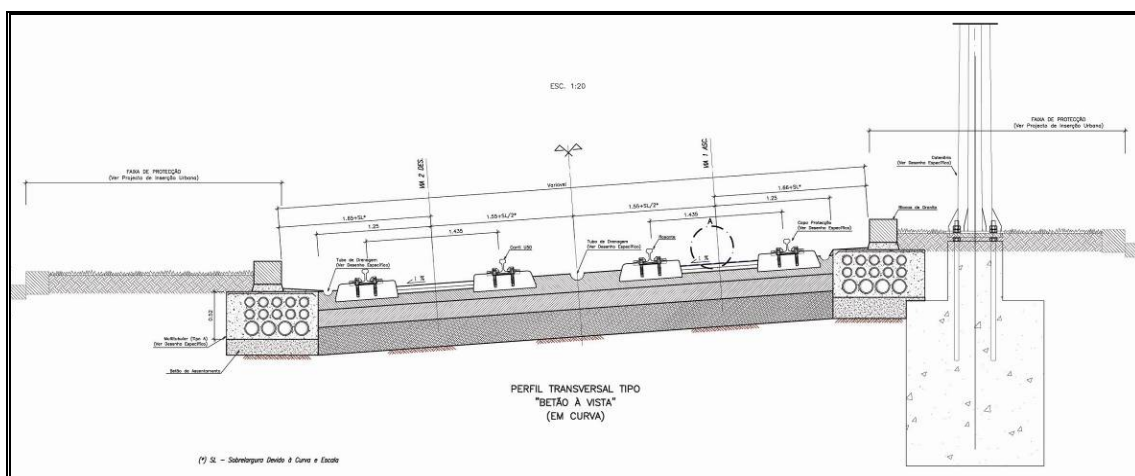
Perfil Transversal Tipo "Betão à Vista"
